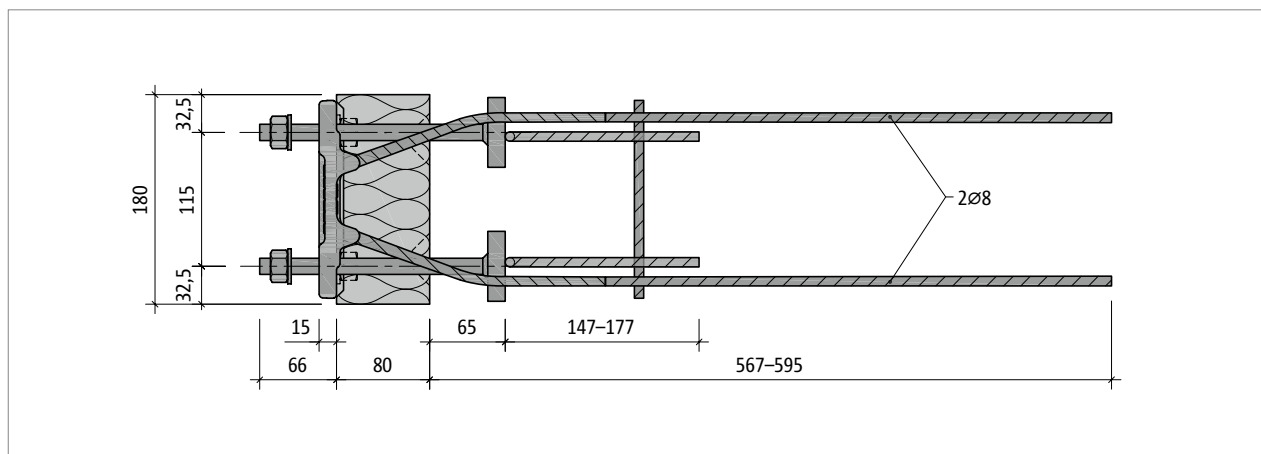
Schöck Isokorb® T type SQ-V1 : plan de base
